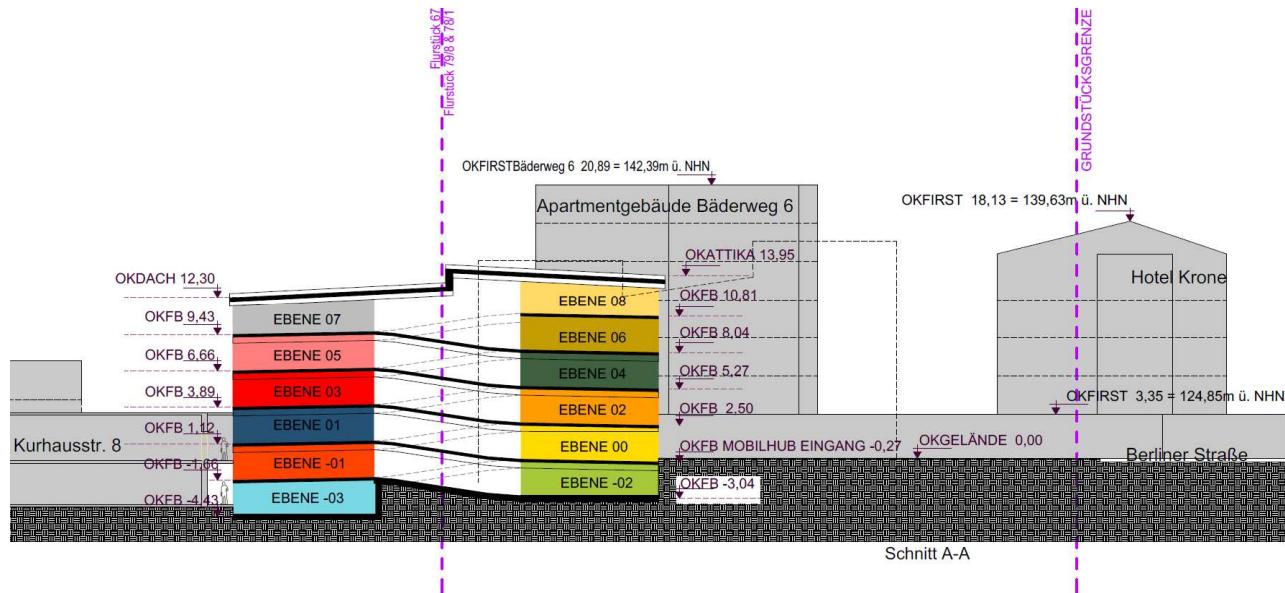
Schnitt durch den geplanten Baukörper der Mobilitätsstation mit Bezug zur umgebenden Bestandsbebauung (Quelle: Franken Generalplaner GmbH, Frankfurt; hier unmaßstäblich).
